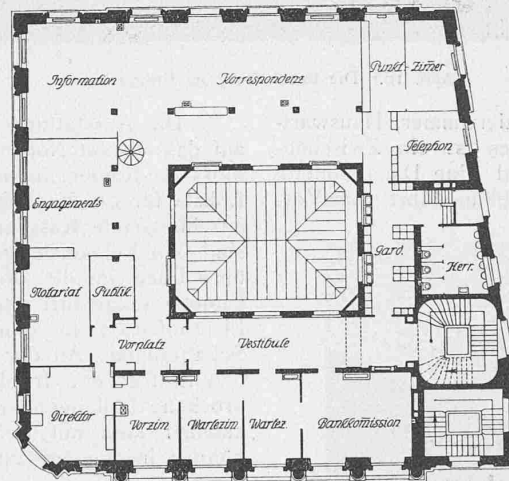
Grundriss vom ersten Obergeschoss.
